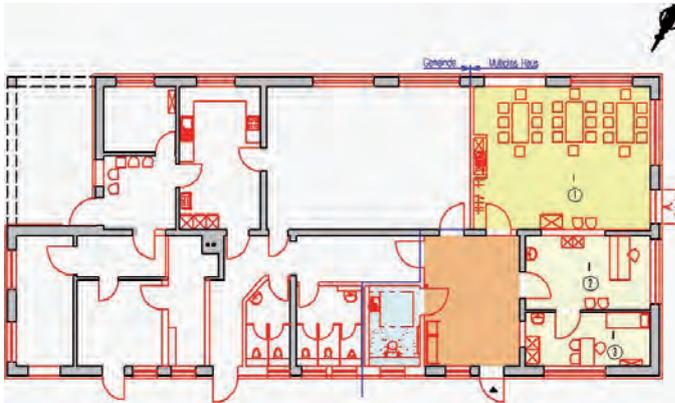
Grundriss „Alter Dorfladen m.H.“
